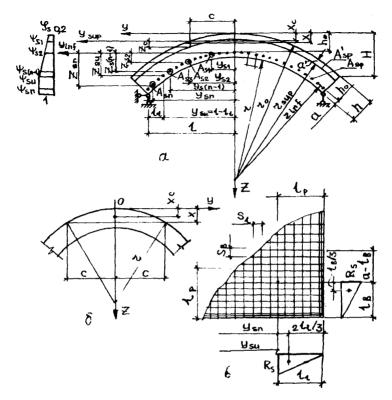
К расчету гибкой плиты-пологой цилиндрической оболочки а-сечение оболочки по линии излома 1-2+2-1; 6-параметры сегмента высотой х; в-длина зон передачи напряжений и напряжений и напряжения в арматуре угловых зон оболочки
